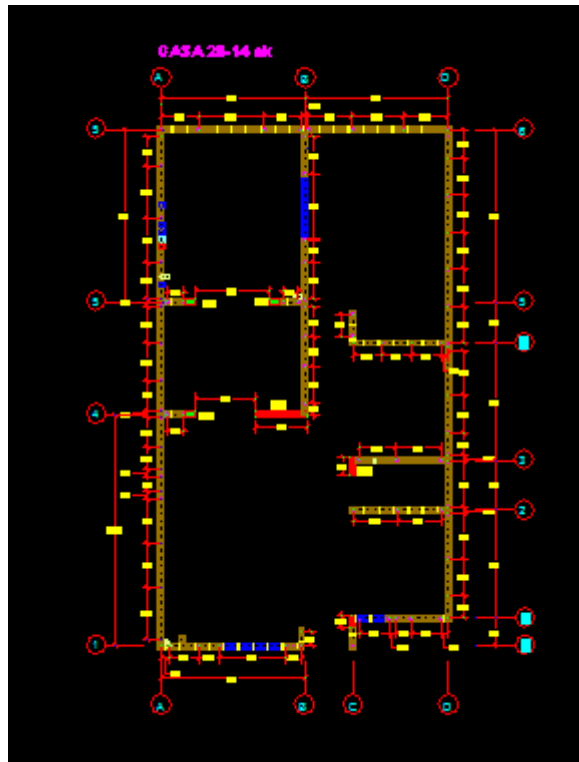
Planteo de muros e instalación de ductos hidráulicos
